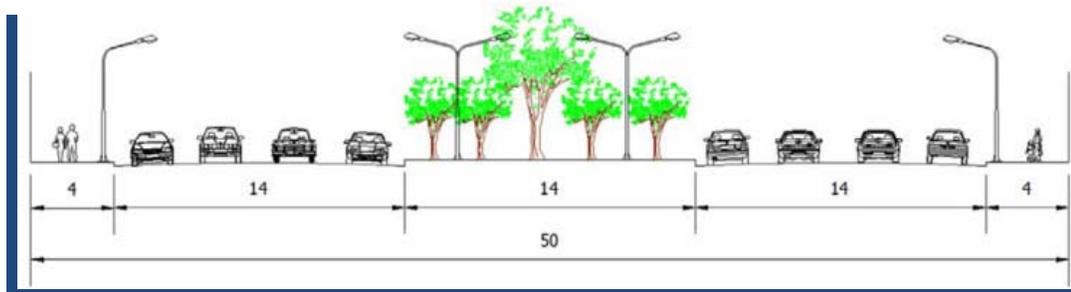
Sección de calle Tipo para el diseño de vialidades primarias.
